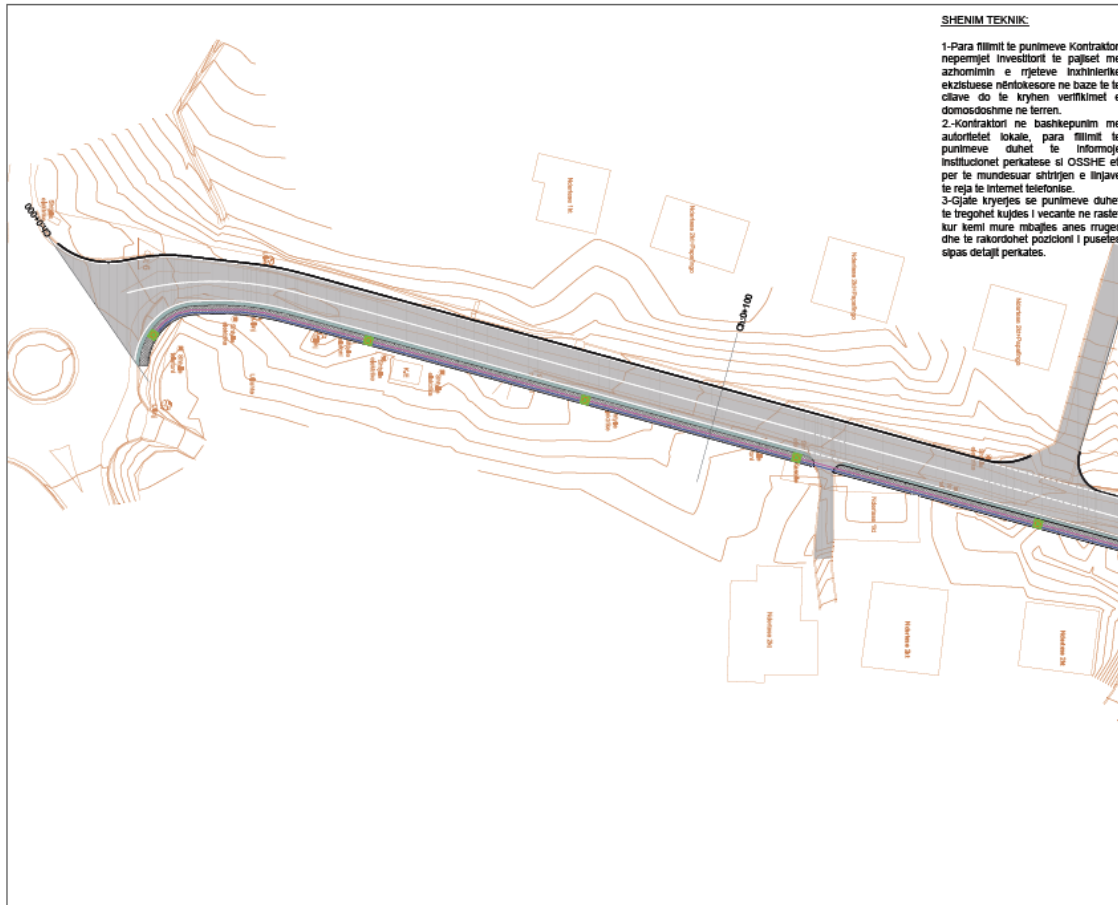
Planimetria e rrjetit elektrik nentokësor
